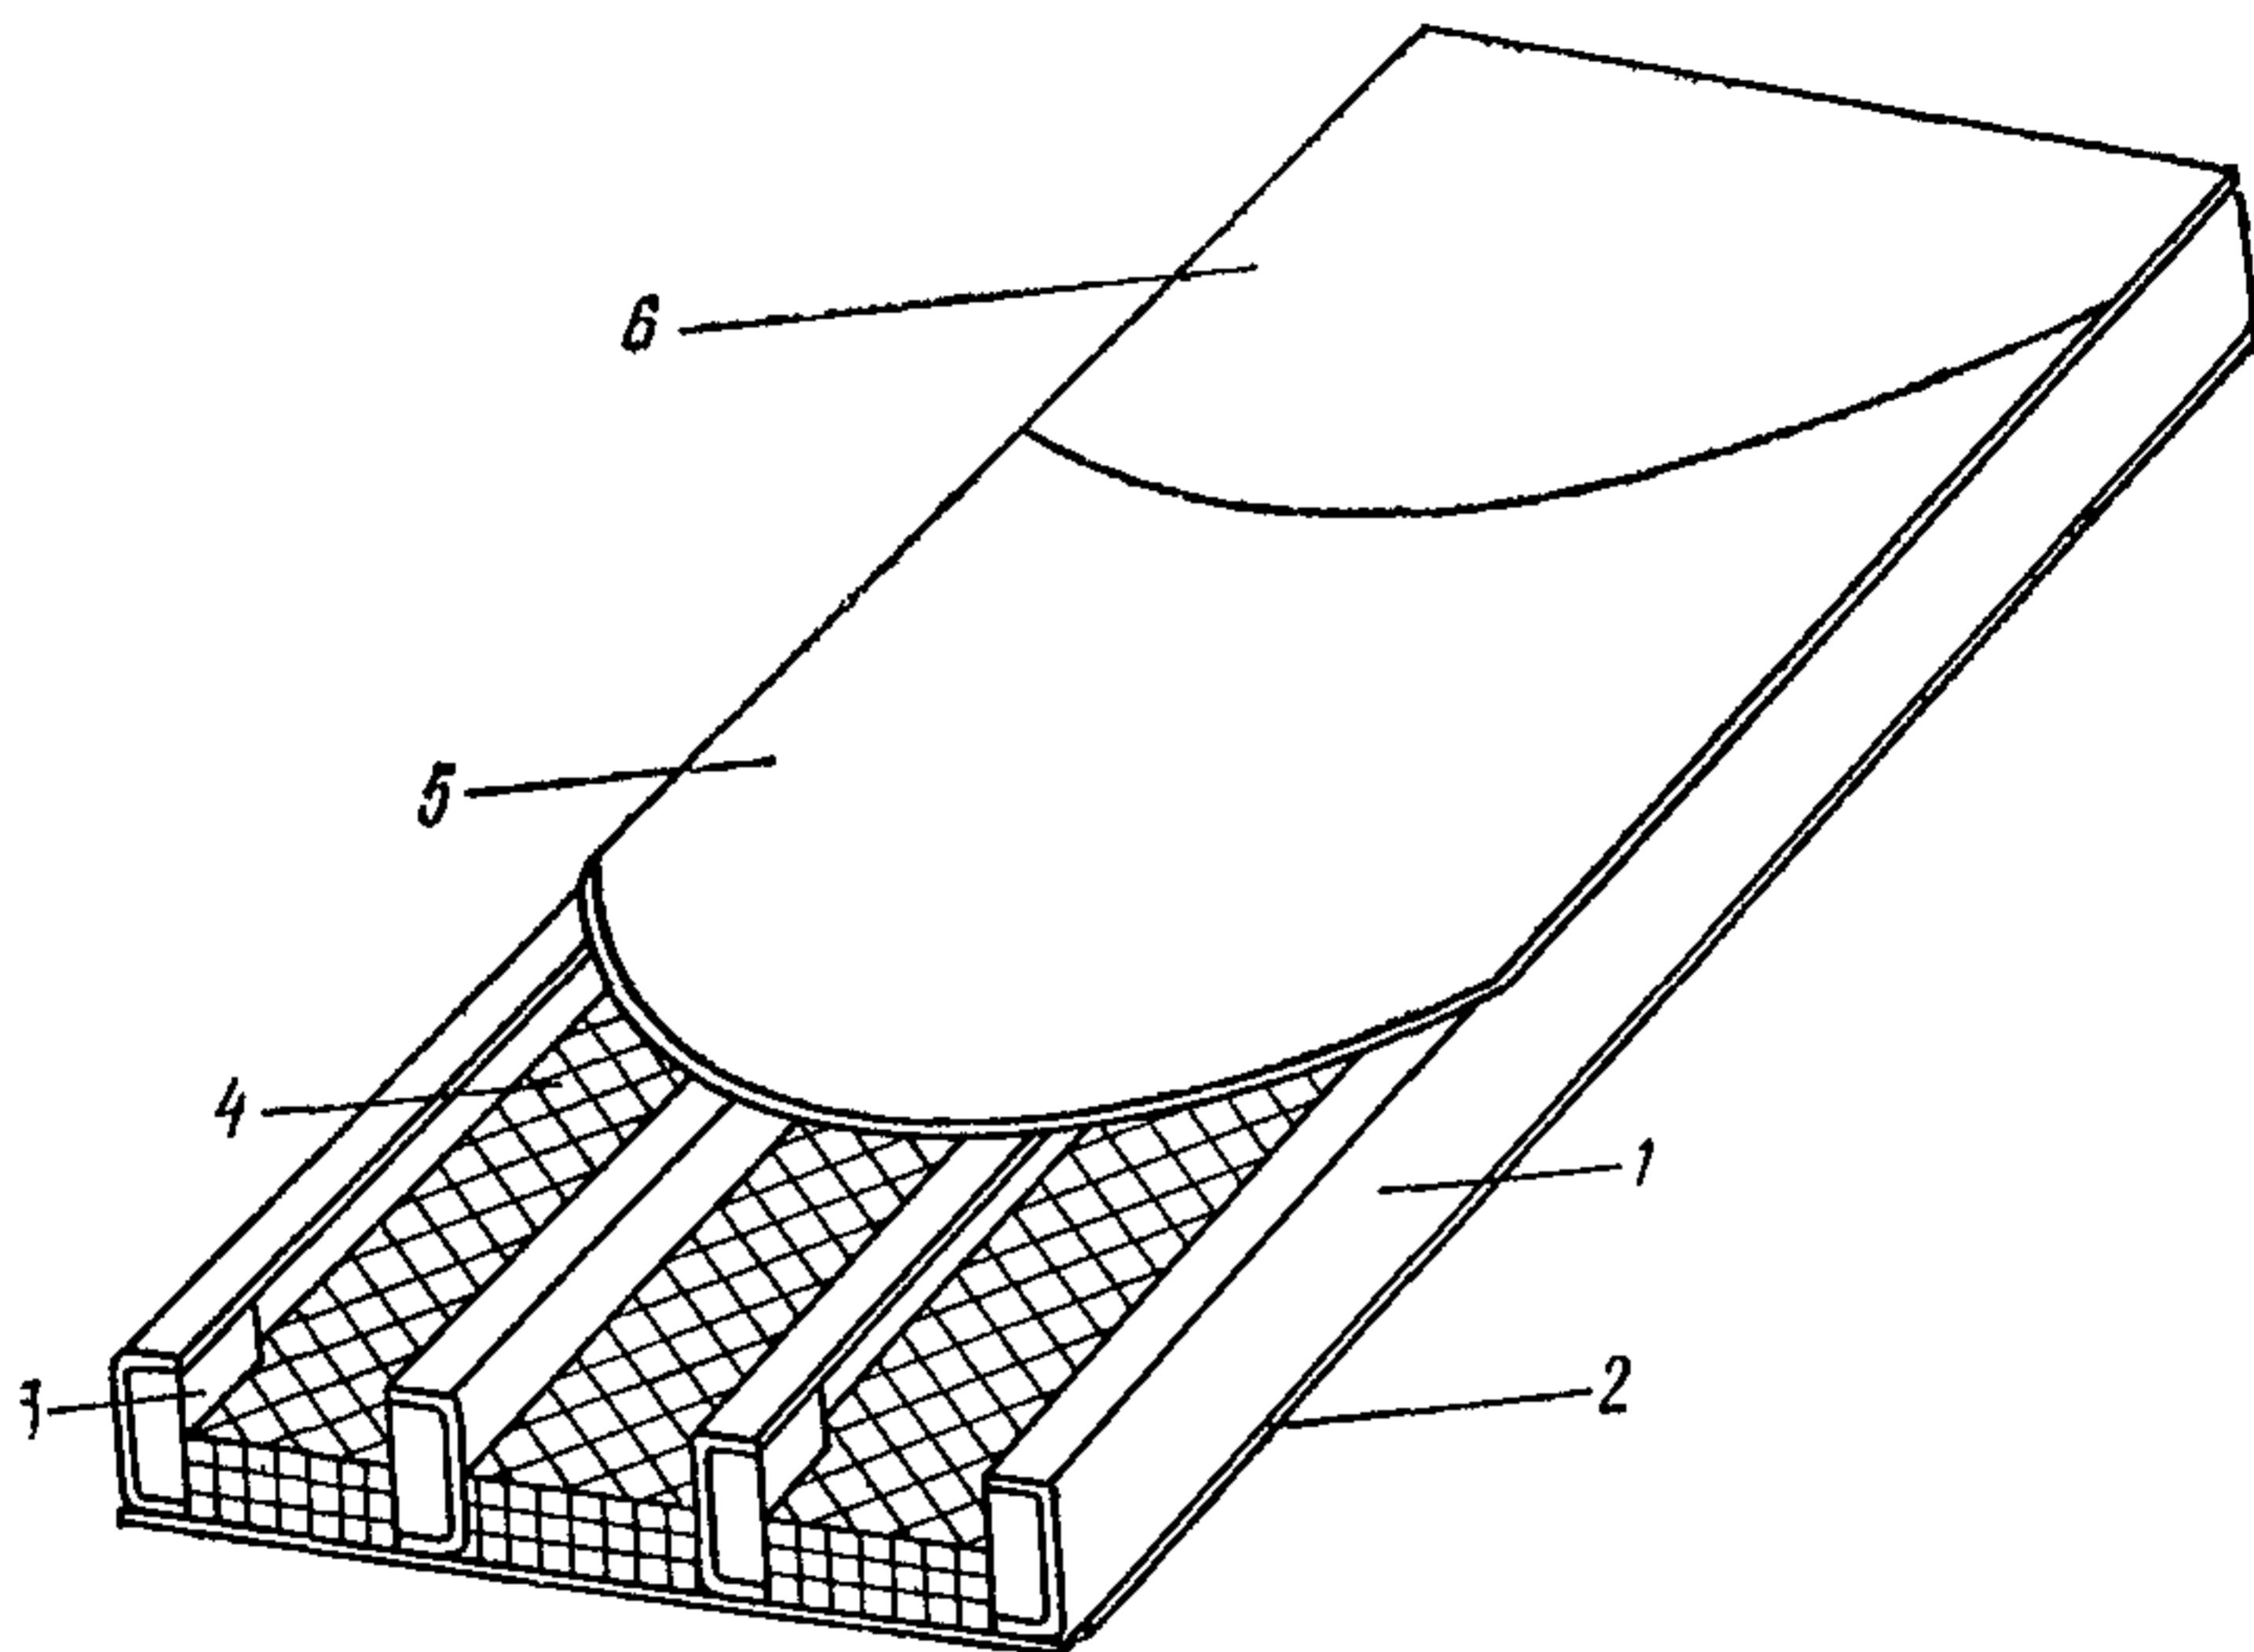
Конструкция плиты покрытия с ребрами из гнутоклеенных фанерных профилей
